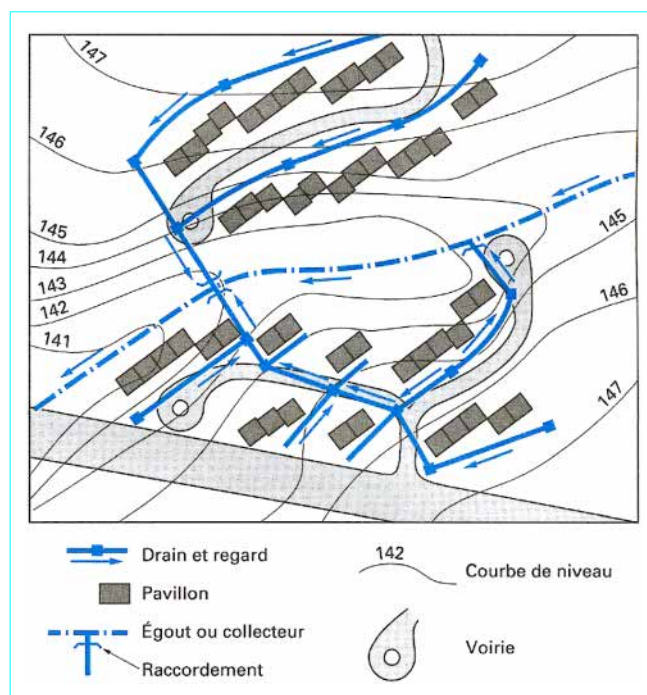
Exemple de drainage collectif d'un lotissement sur un terrain en pente.
